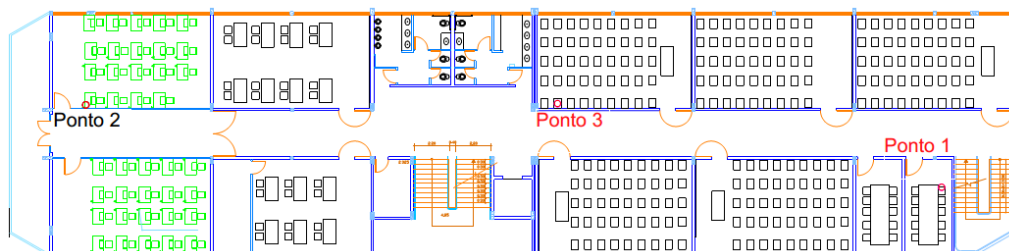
Localização dos Xbees na planta do Primeiro Pavimento do Bloco C67, da UEM, sem escala.
